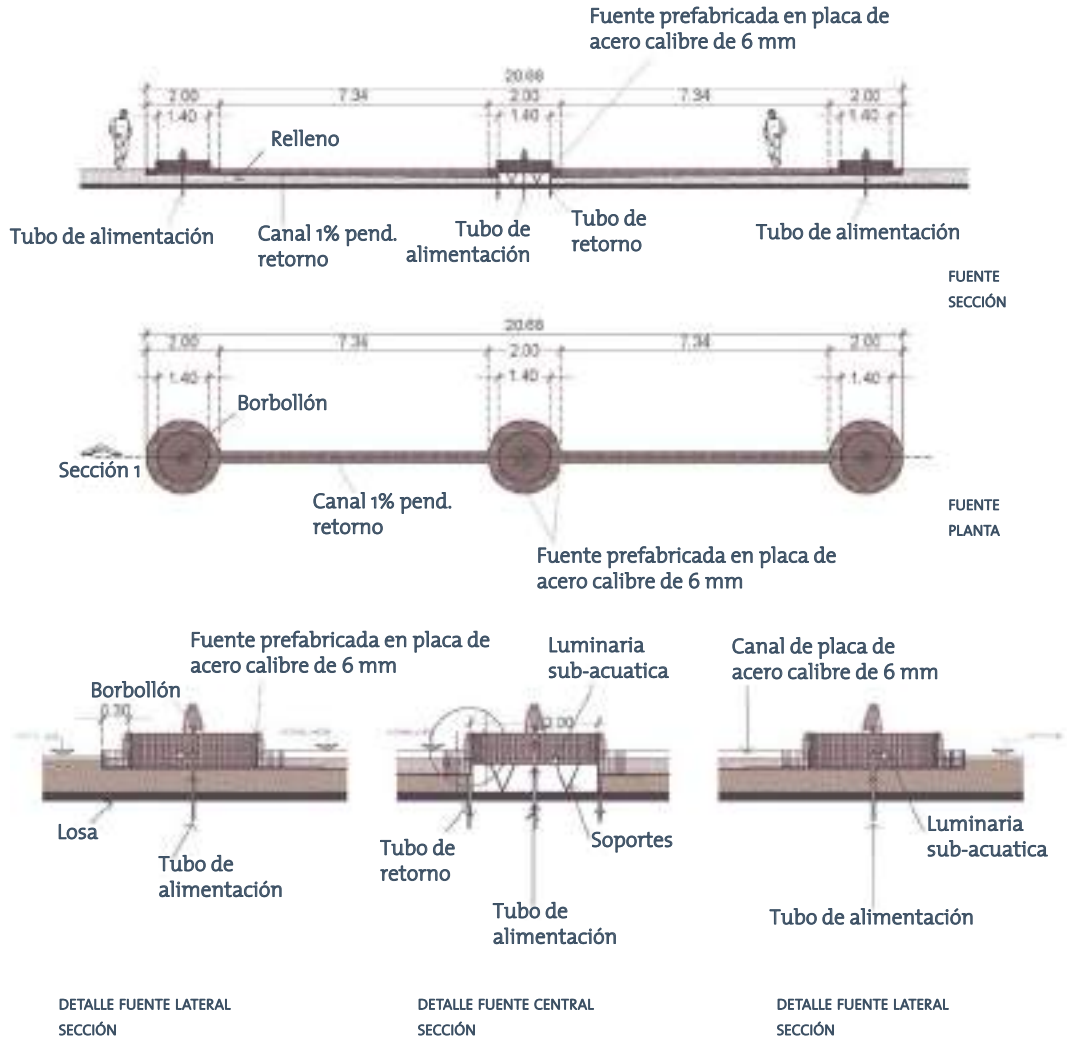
Fuentes fabricadas con placa de acero, en una plaza
